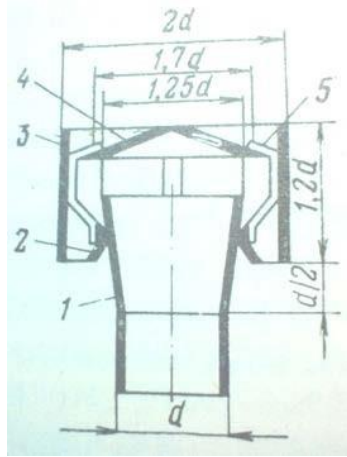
Схема дефлектора конструкції ЦАГІ:
